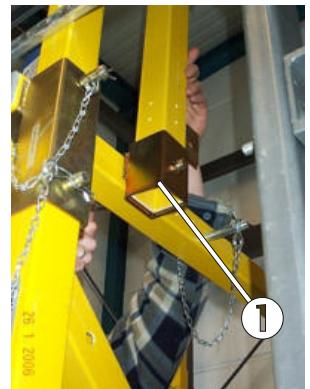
Positionierung des Aufnahmeteils inklusive oberer Geländerstütze
